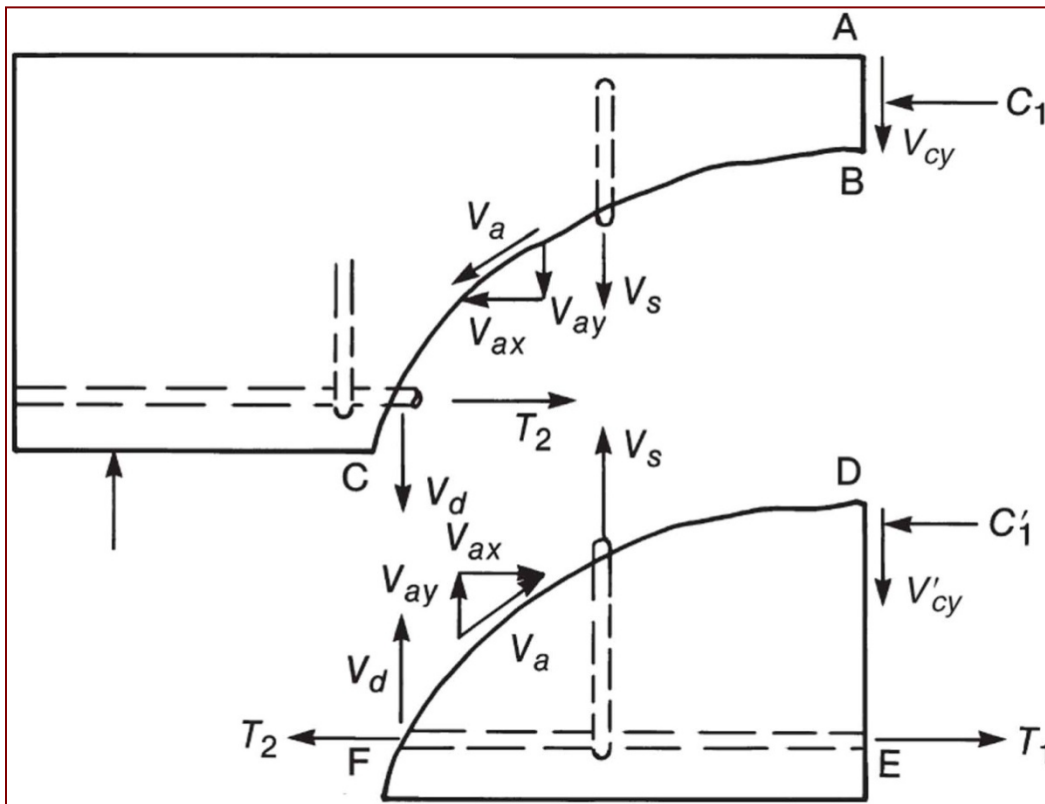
Fuerzas internas en una viga agrietada y con estribos.
